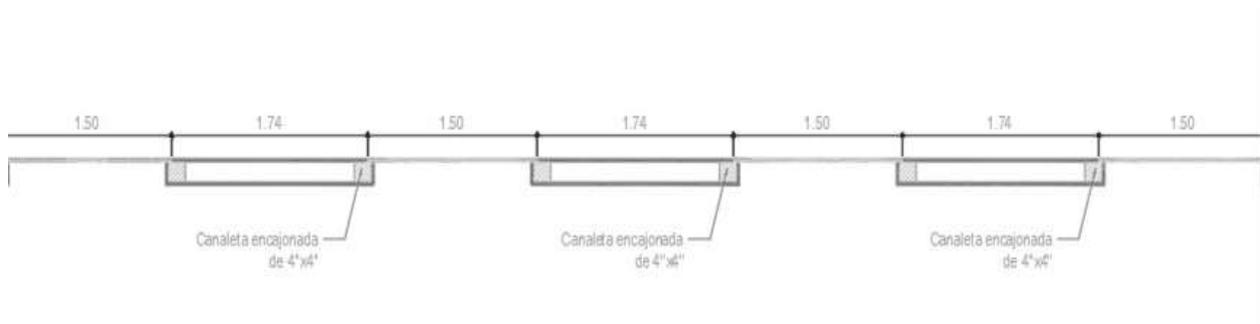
Detalle en Corte de Pérgola en Azotea
